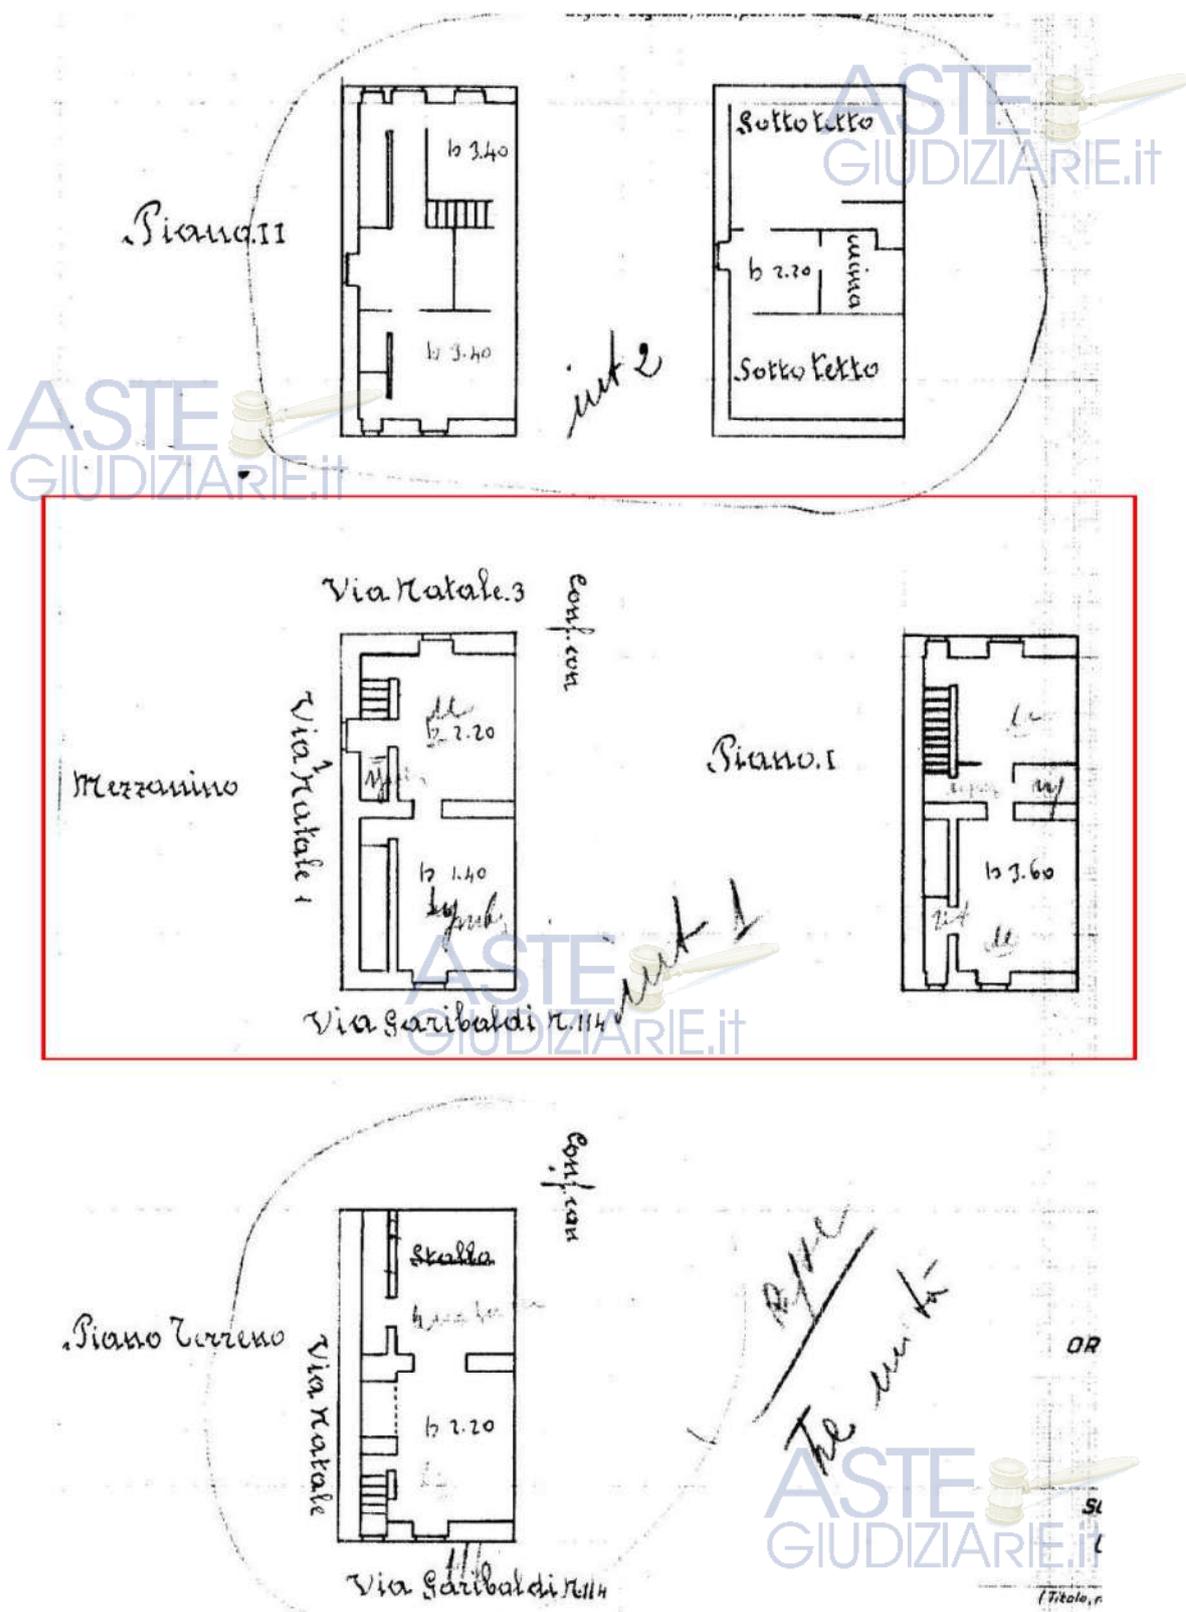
Stralcio planimetria catastale dell'appartamento duplex
